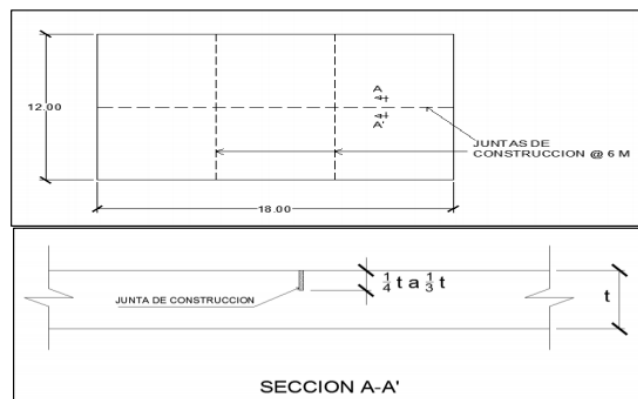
Juntas constructivas en un pavimento de concreto permeable
